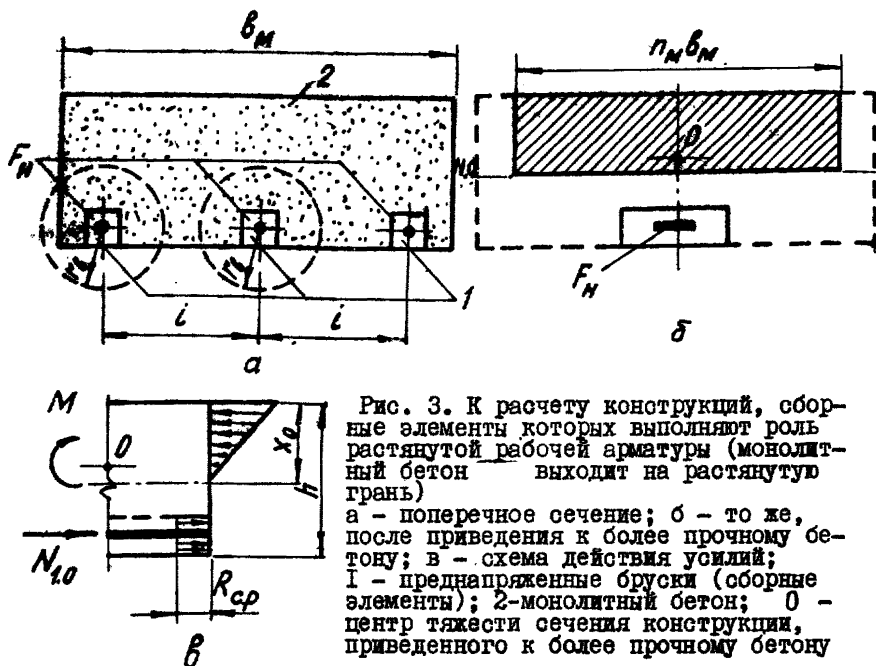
К расчету конструкций, сборные элементы которых выполняют роль растянутой рабочей арматуры (монокристаллический бетон выходит на растянутую грань)
